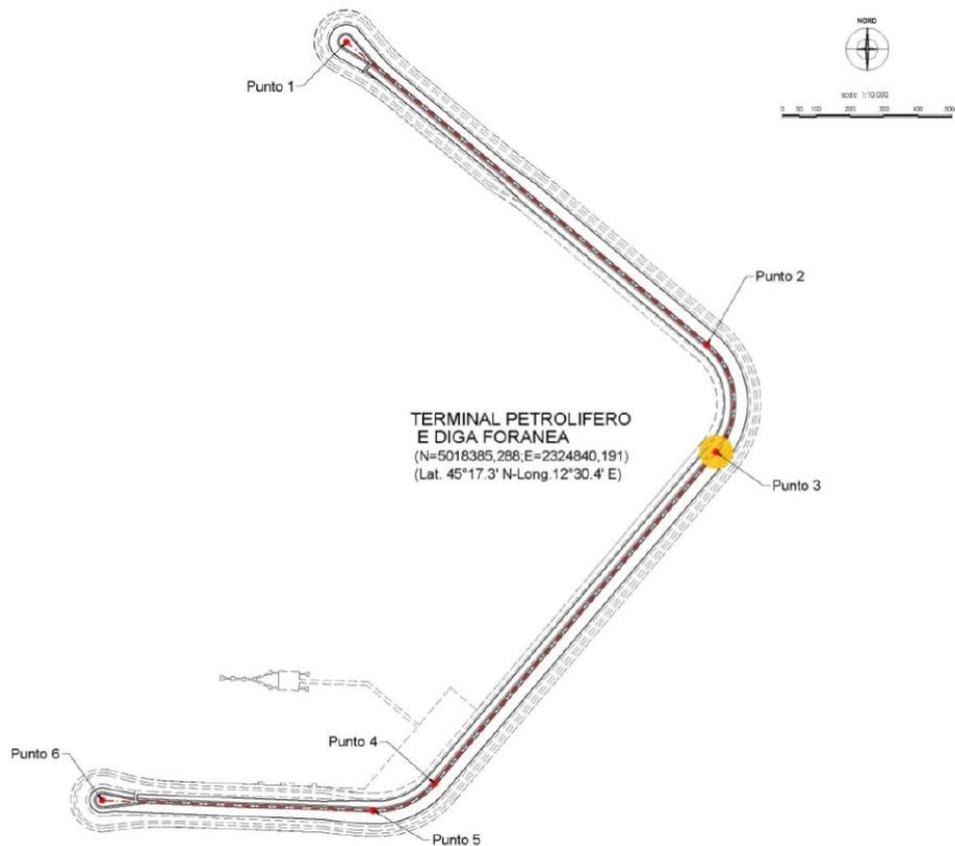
Inquadramento Planimetrico Diga Foranea
